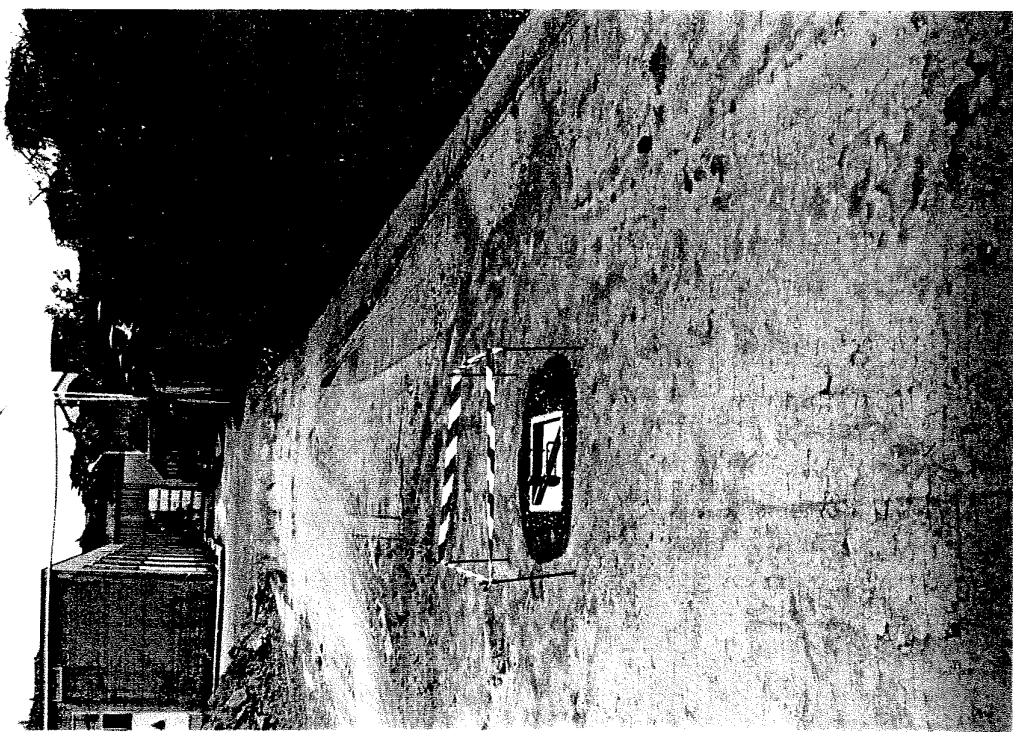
Punto 2 pozzetto di prova della permeabilità in sito.
